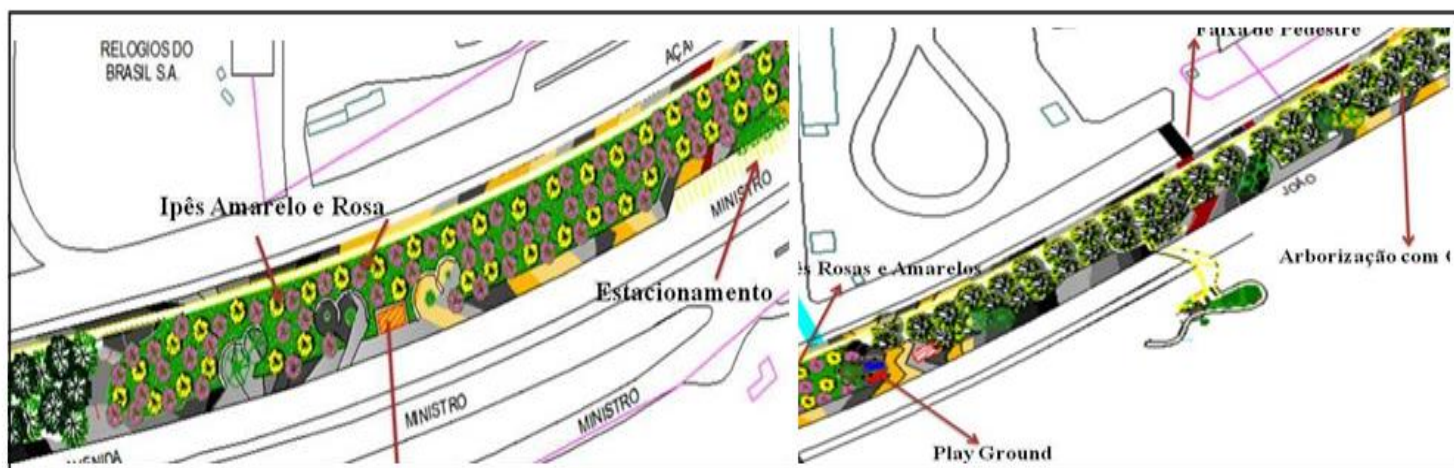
Planta de layout da 3ª e 4ª parte do Calçadão da SUFRAMA. Fonte: Autores, (2016).
